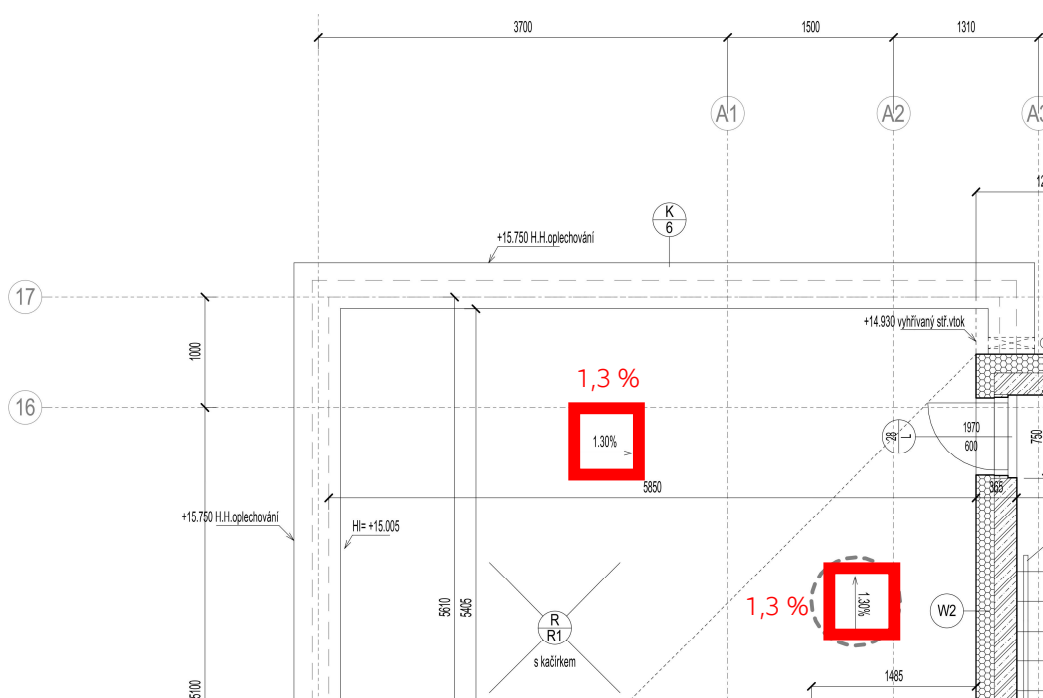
Půdorys střechy objektu B (výřez) – sklon střechy
